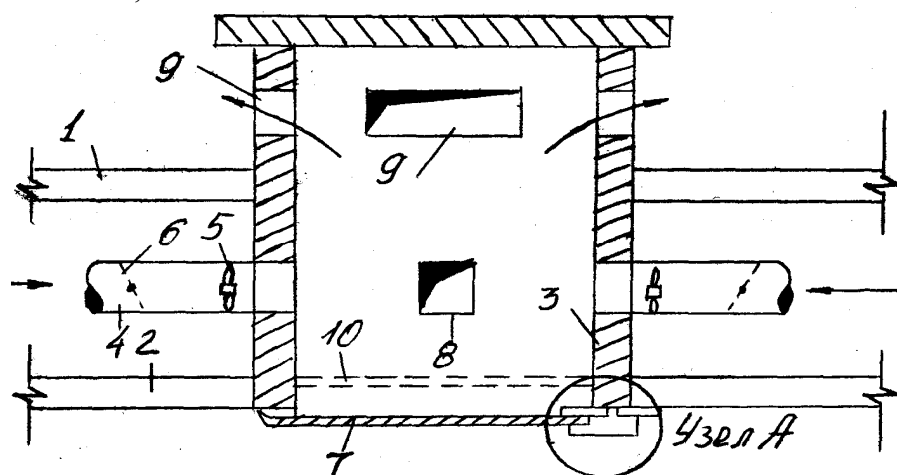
Дымовая вентиляционная шахта ДВШ в чердачном помещении (вариант 1): 1-покрытие; 2-чердачное перекрытие; 3-вентиляционная шахта; 4-воздуховоды для вентиляции чердачного помещения; 5-вентиляторы; 6-автоматическая задвижка; 7-дымовой клапан; 8-проем для очистки и ремонта шахты; 9-вытяжное отверстие; 10-лоток для сбора конденсата
